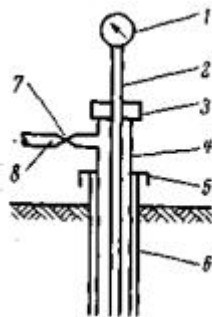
Схема запорного приспособления при самоизливе из скважины:
